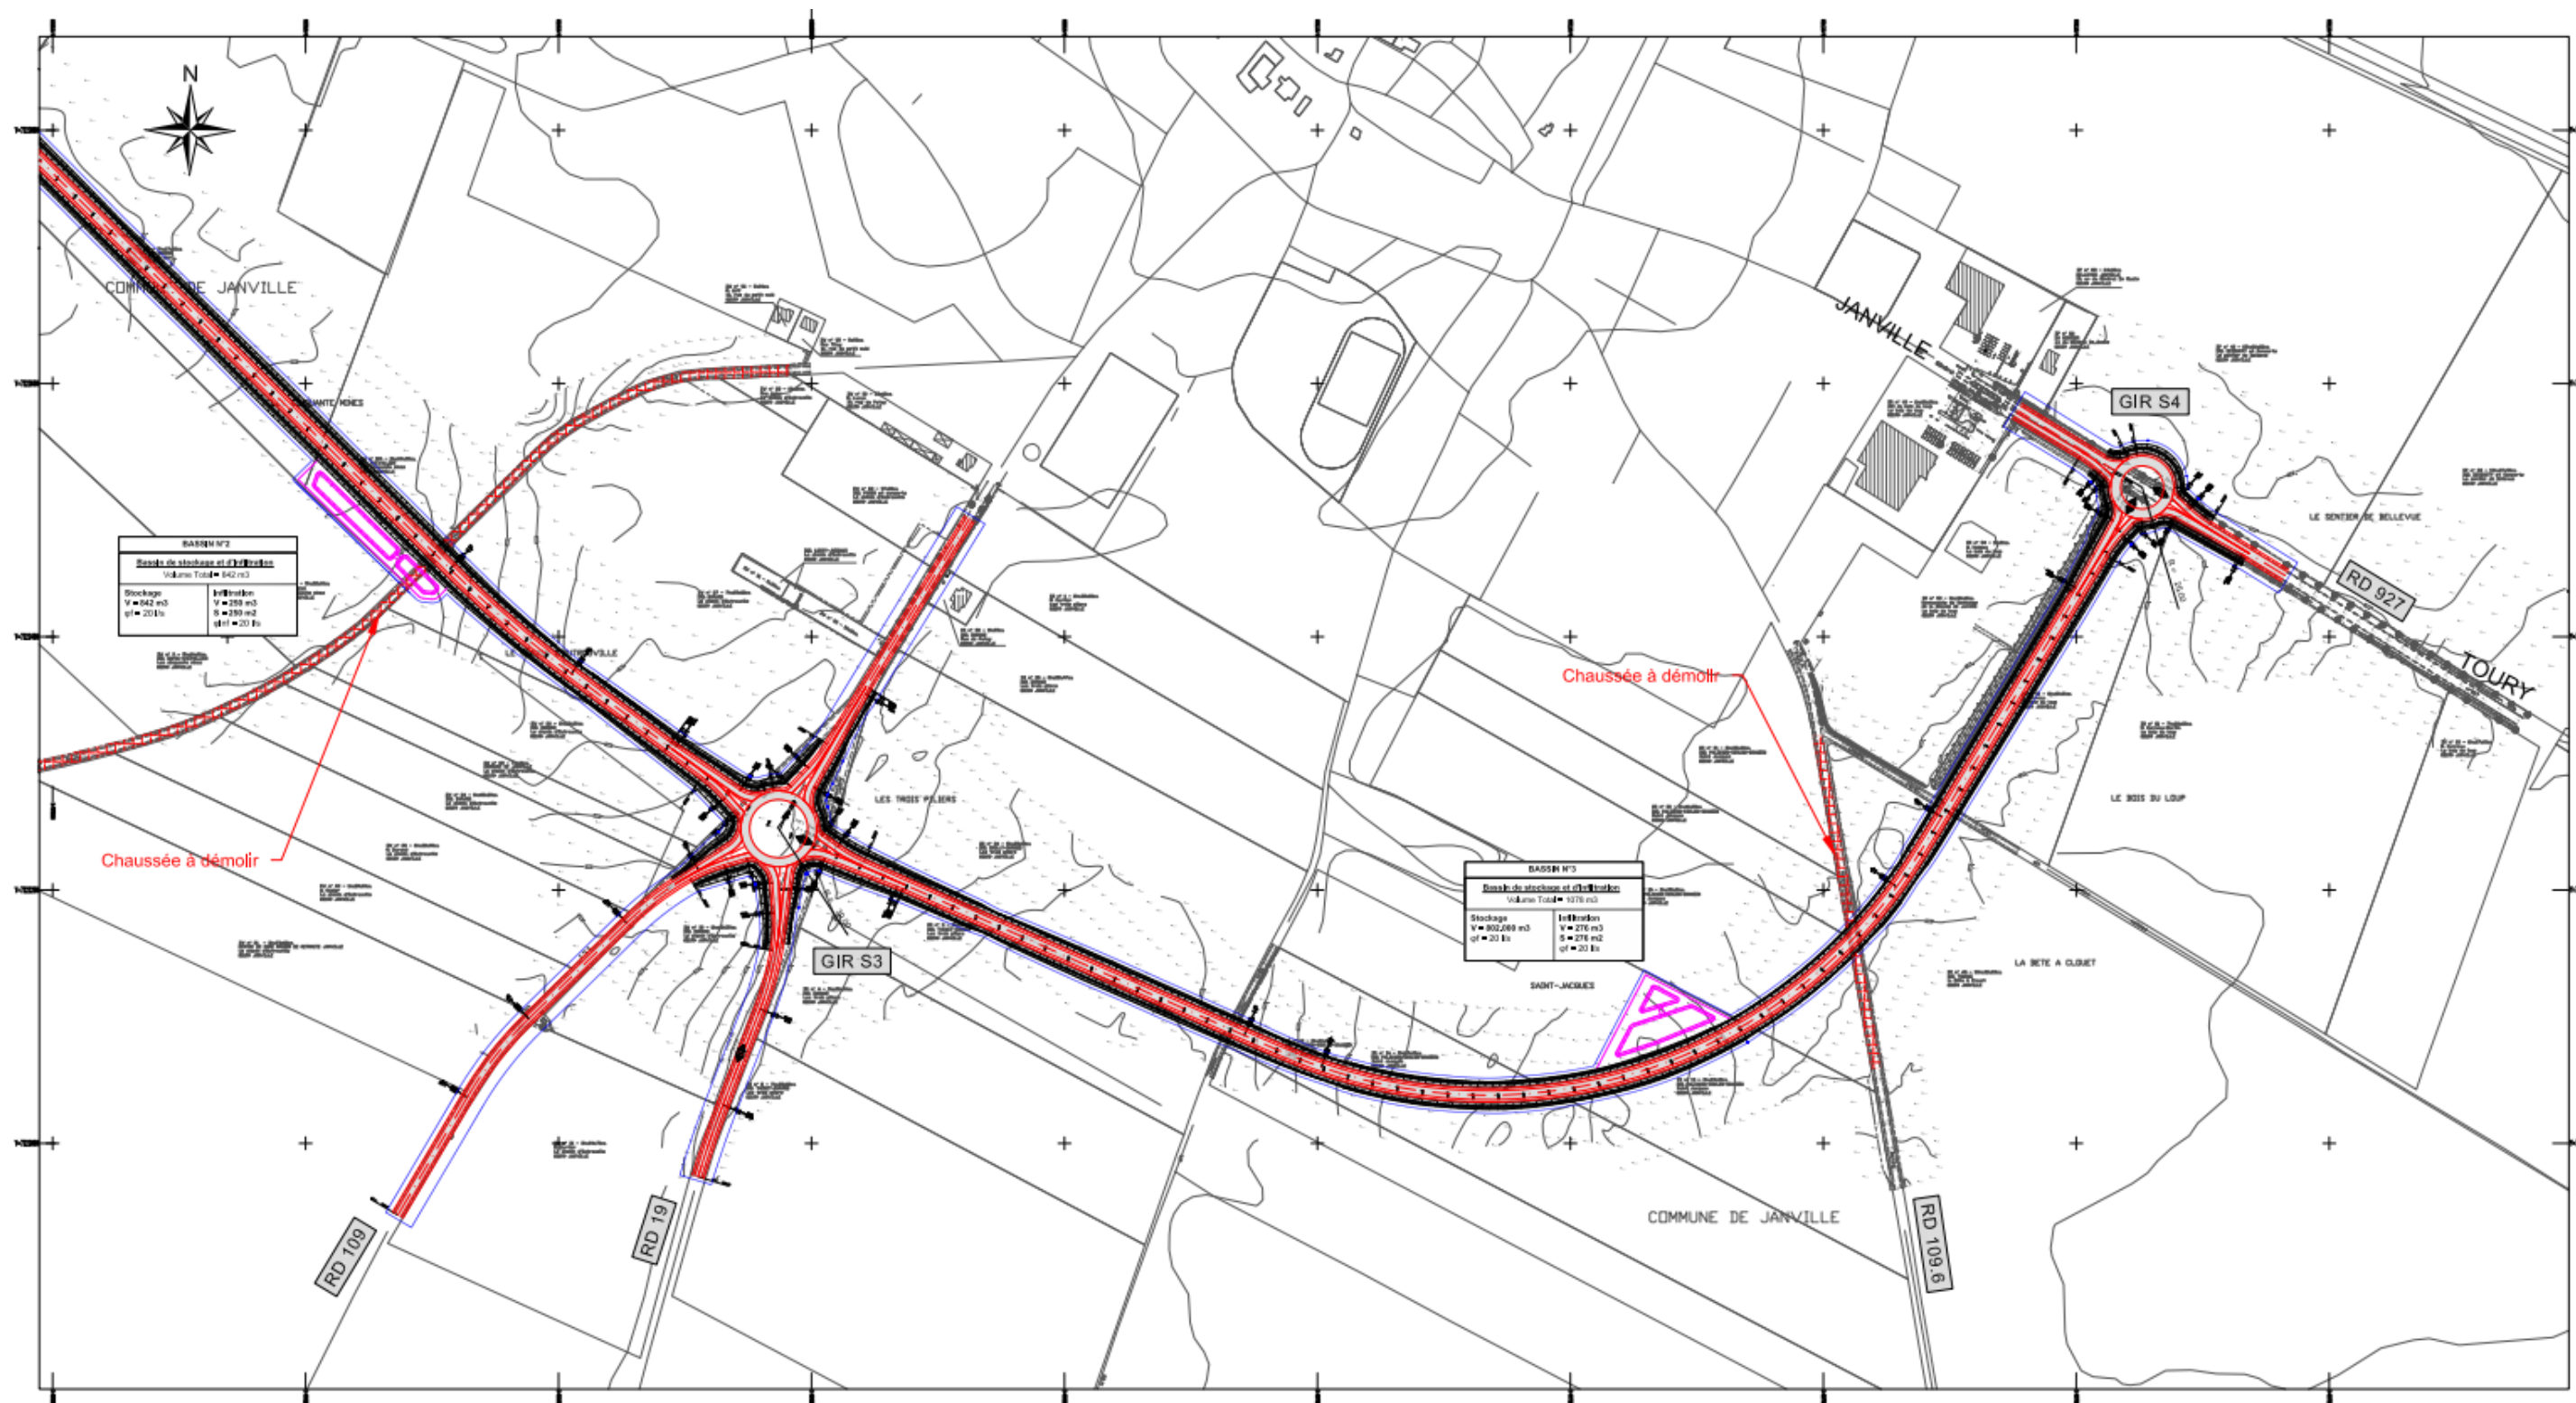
Vue en plan 2/4 du projet (section Le Puiset-Janville)
